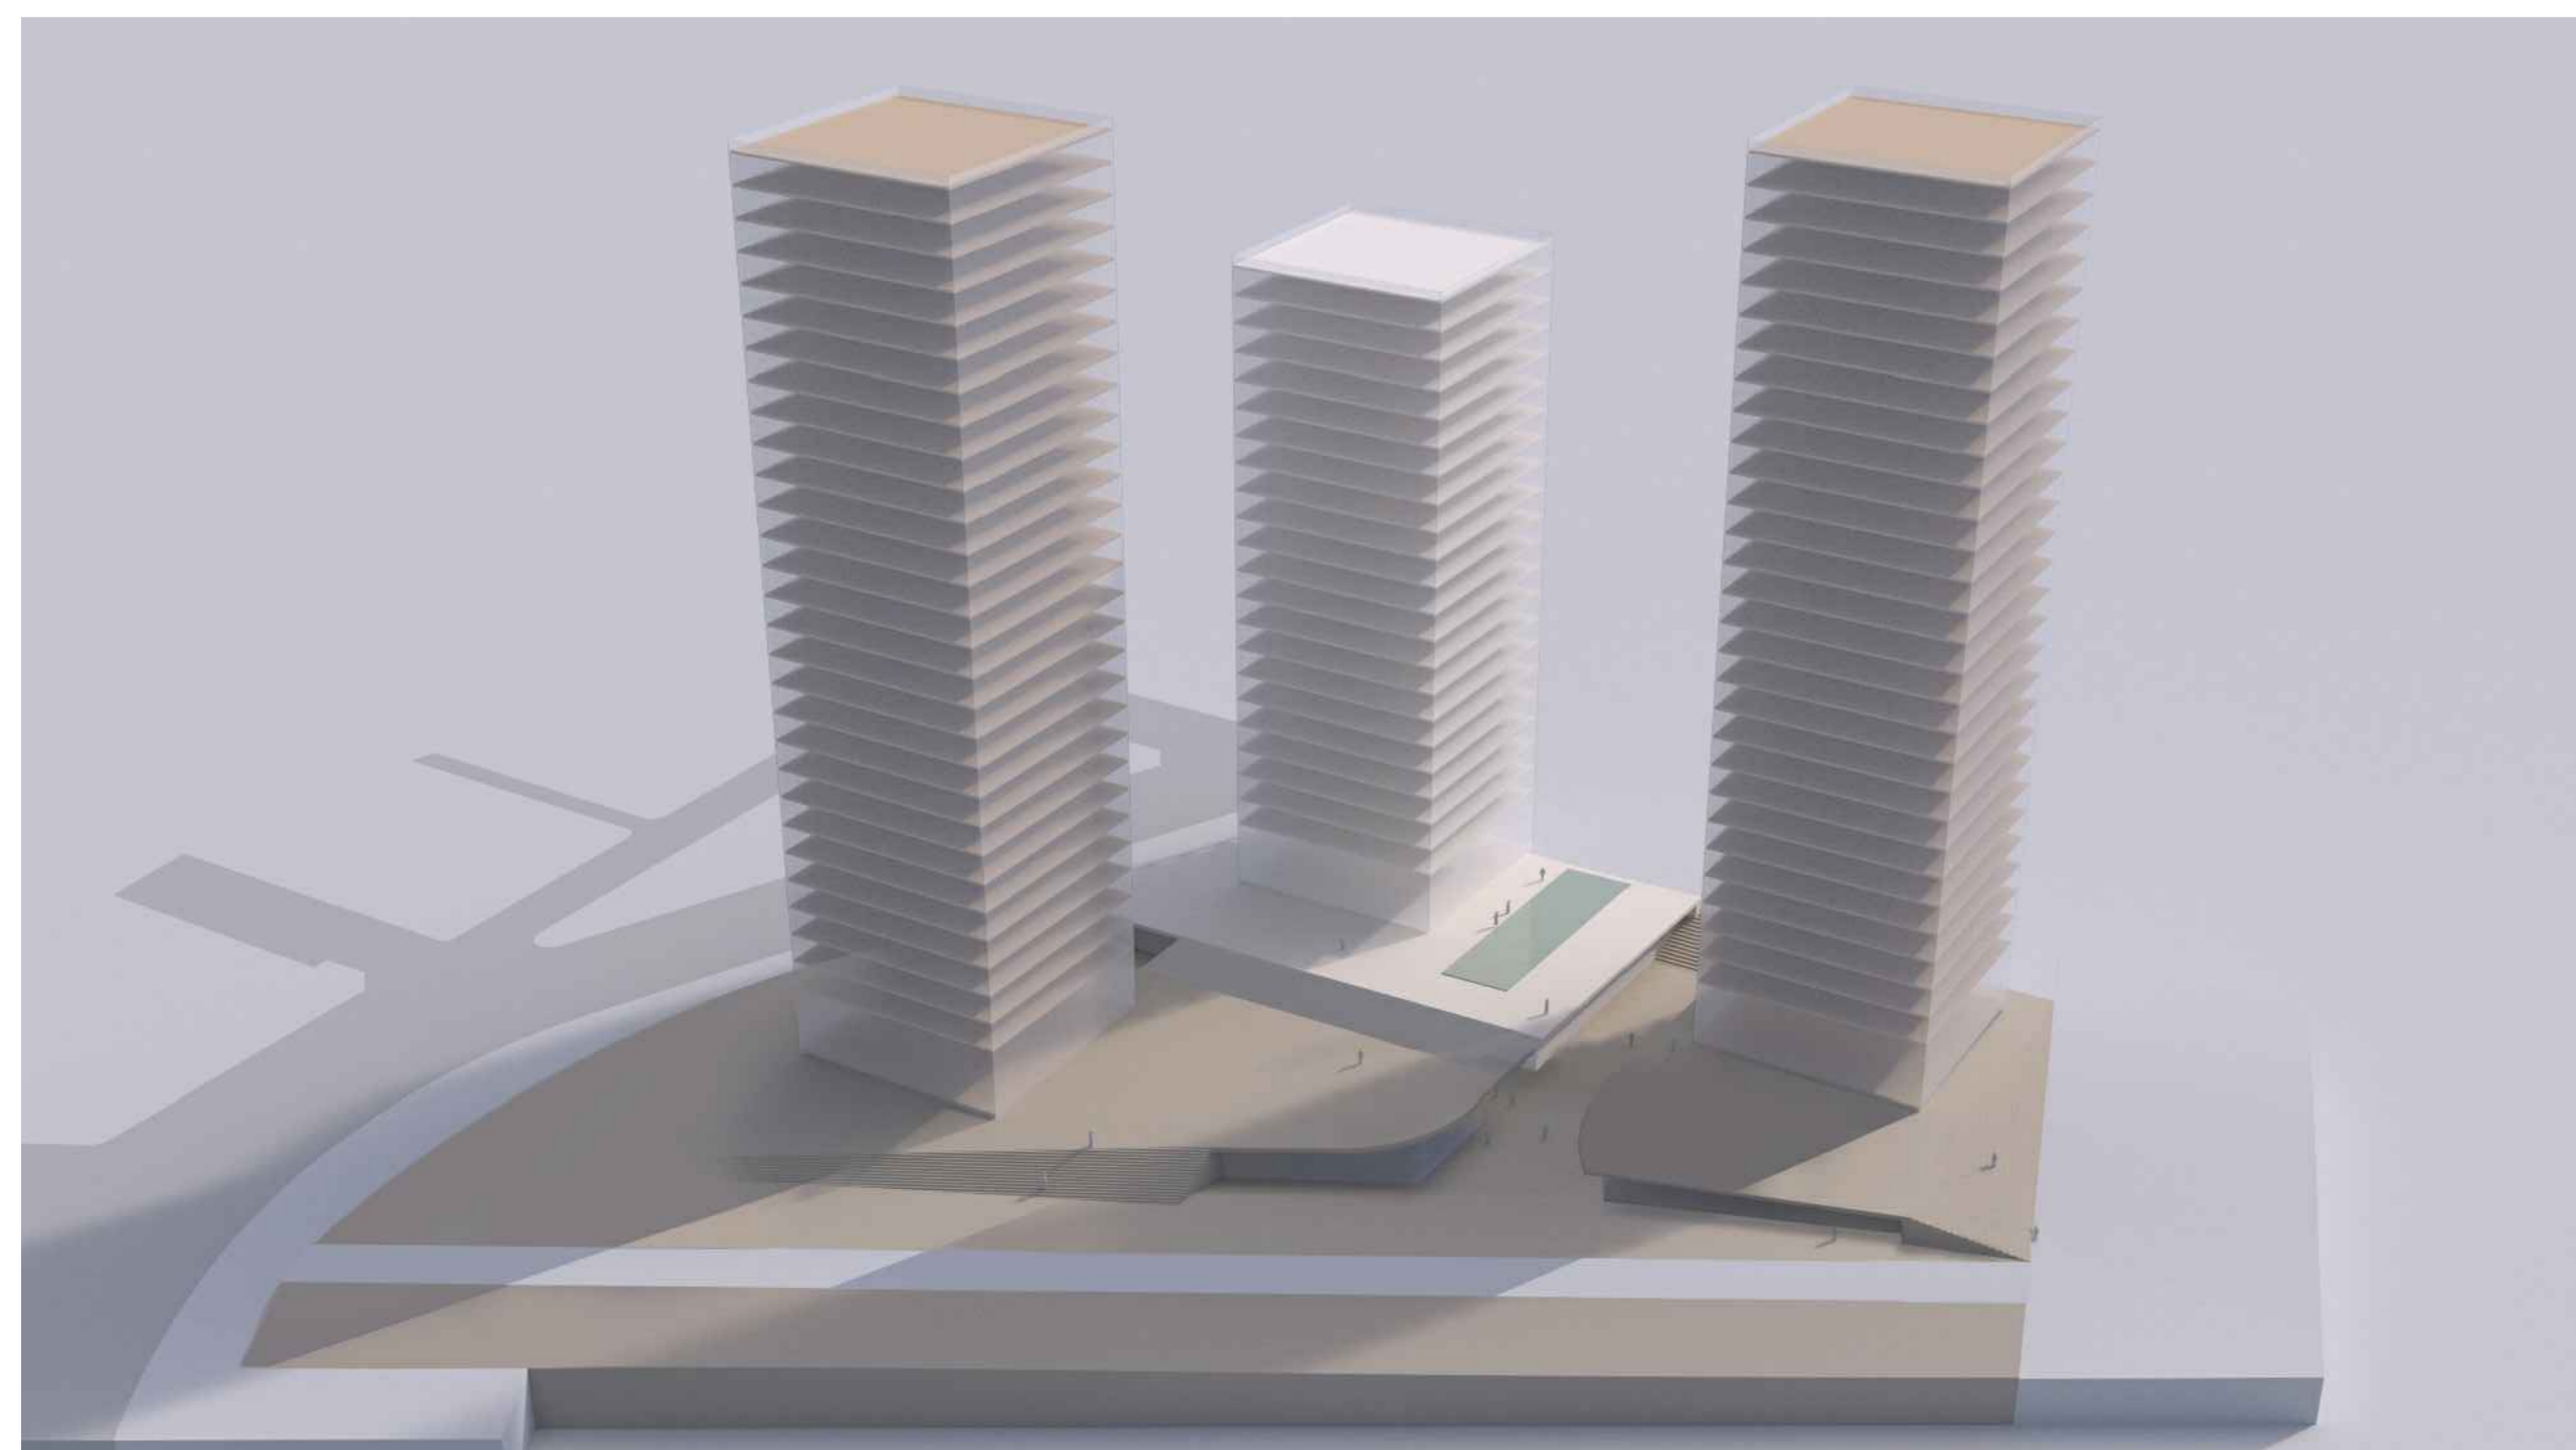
IMAGEN DE LA PROPUESTA. VOLUMETRÍA
